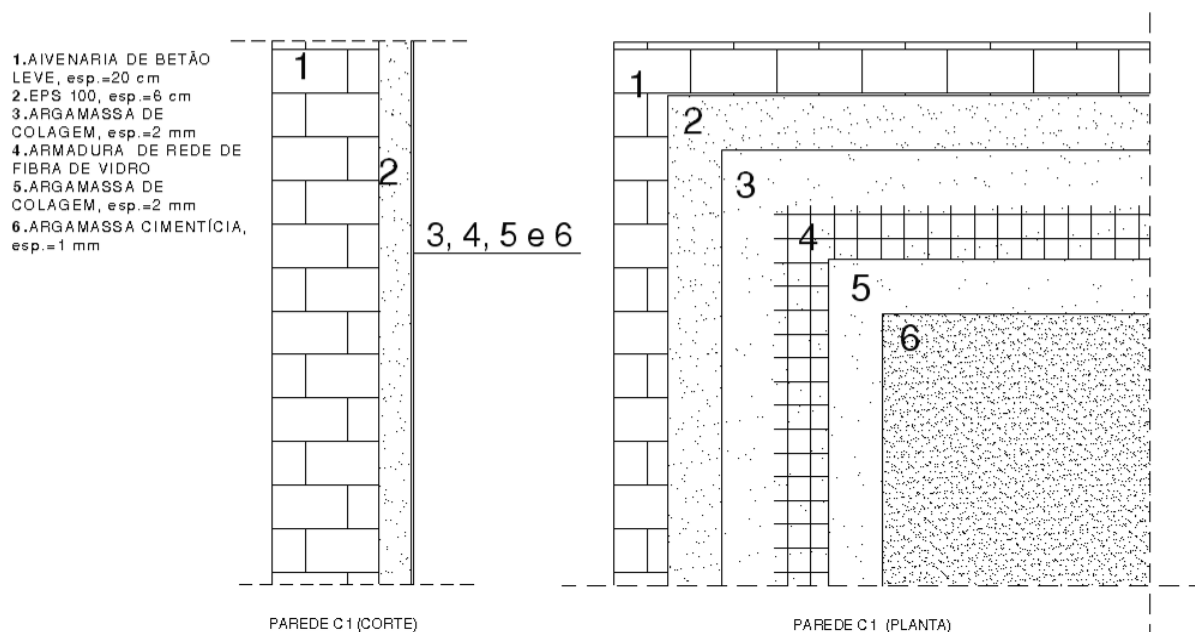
Esquema demonstrativo da constituição do provete (Parede C1 em corte e planta).
